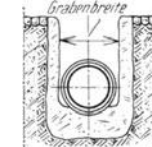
Rohrgraben mit Brücke und Muffenlöchern. (Nach P. Brinkhaus)
